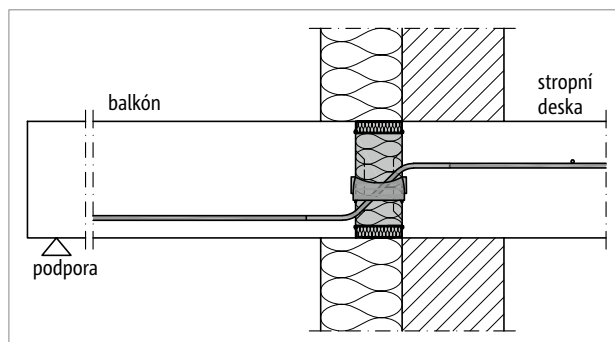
Schöck Isokorb® T typ QLN, QLN-VV: Balkón uložený ze dvou stran, se sloupovou podporou
